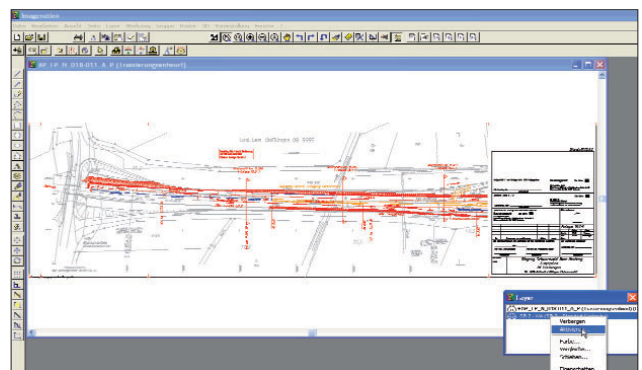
Planprüfung mit dem Spicer Imagination Viewer
